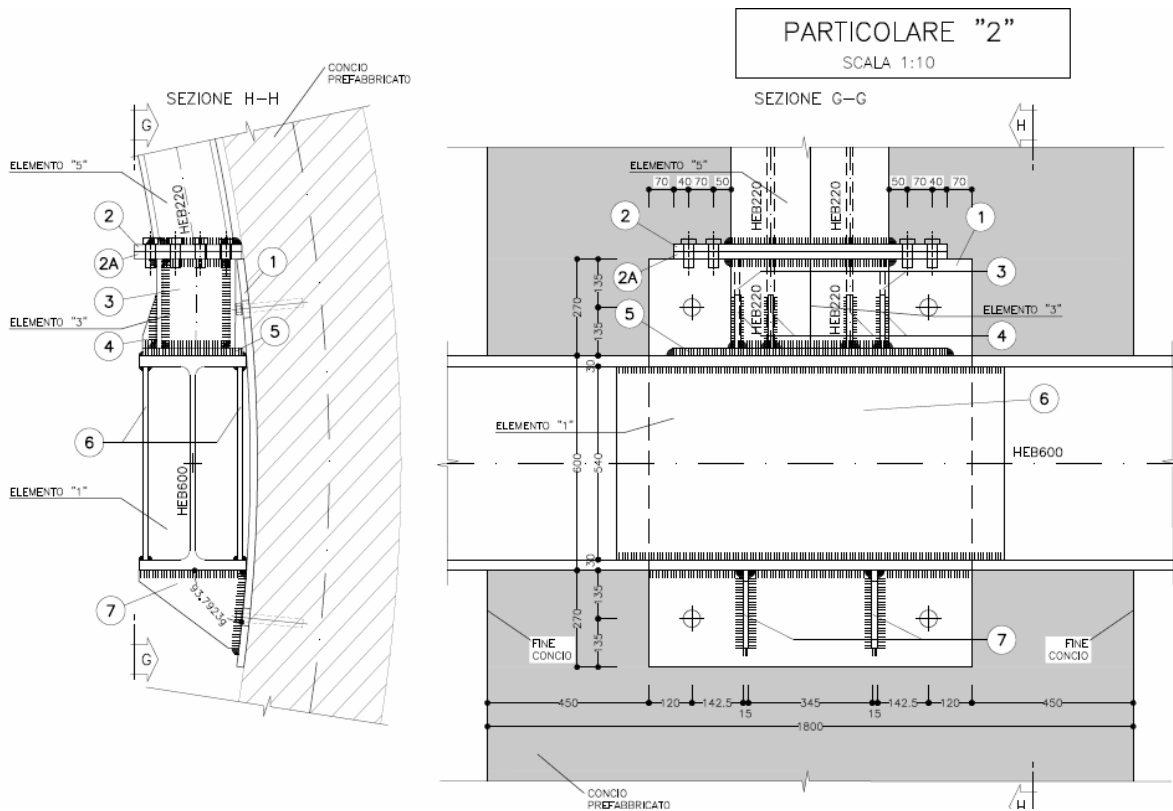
Dettagli di ancoraggio tra trave e conchi prefabbricati
